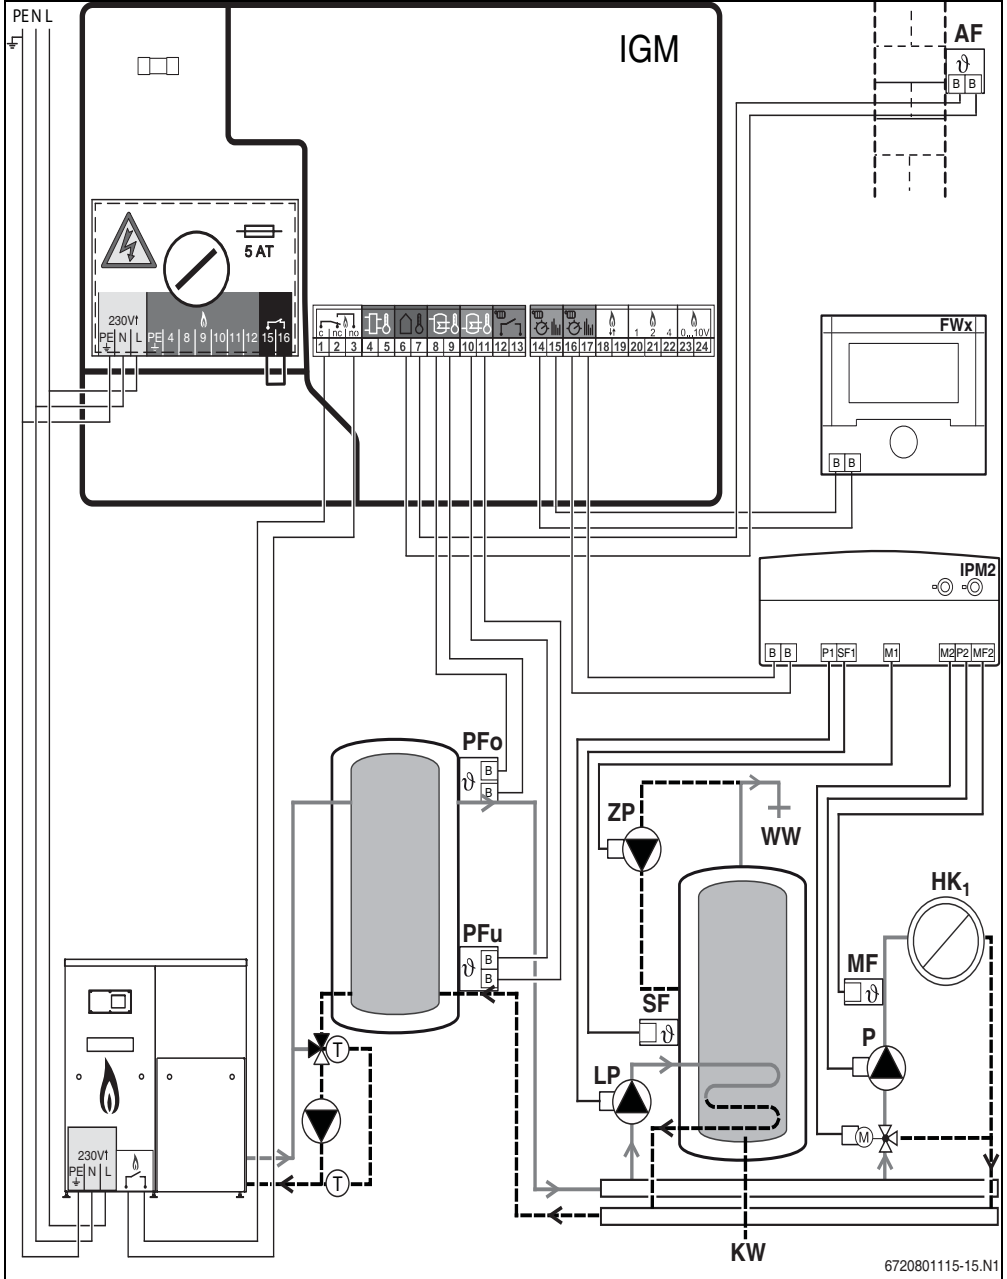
Grundlegender Anschlussplan mit Pufferspeicher
